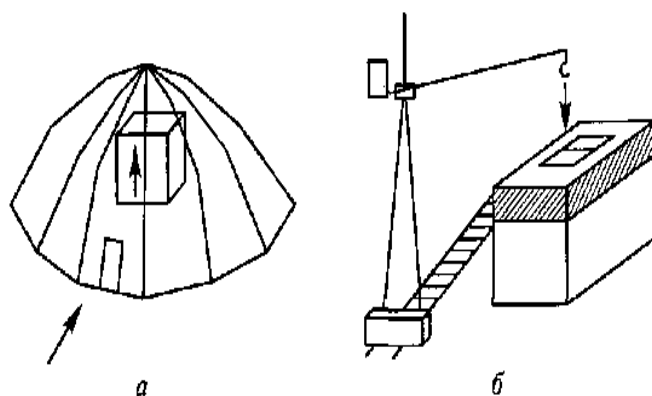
,29. Кладка в пленочных тепляках: а — на все здание (Канада); б — на этаж (Германия). Стрелками показан способ подачи материалов (подъемником и краном).
